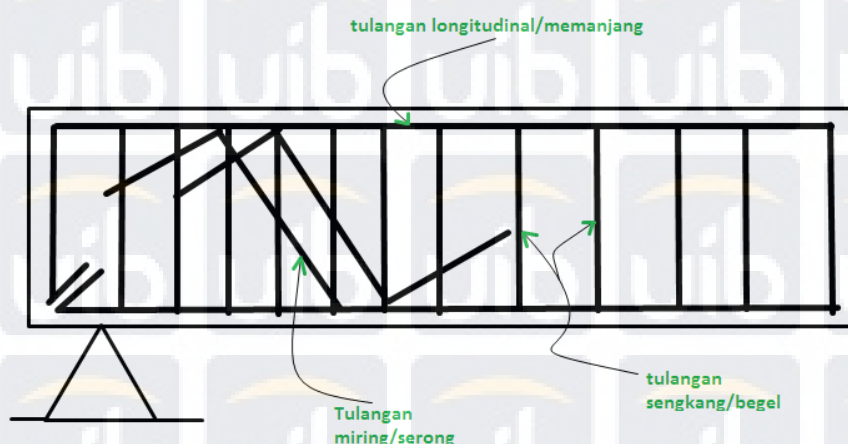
Contoh Pemasangan Tulangan Longitudinal pada Balok dan Plat
